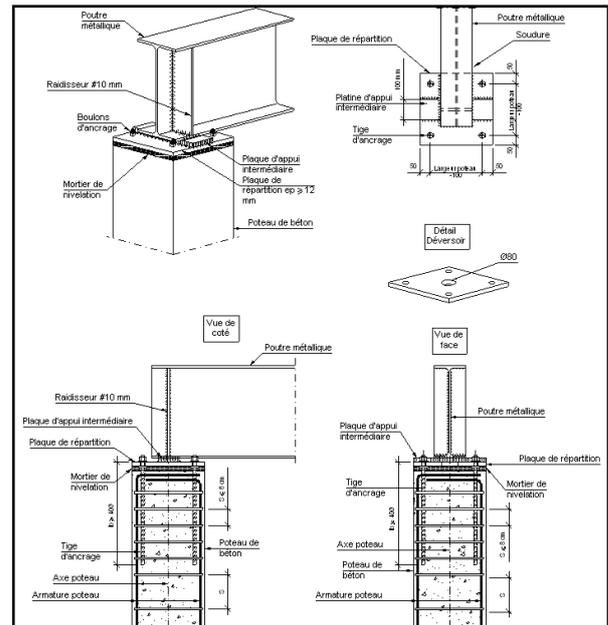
Détail de jonction entre poteau en béton et un poteau métallique
